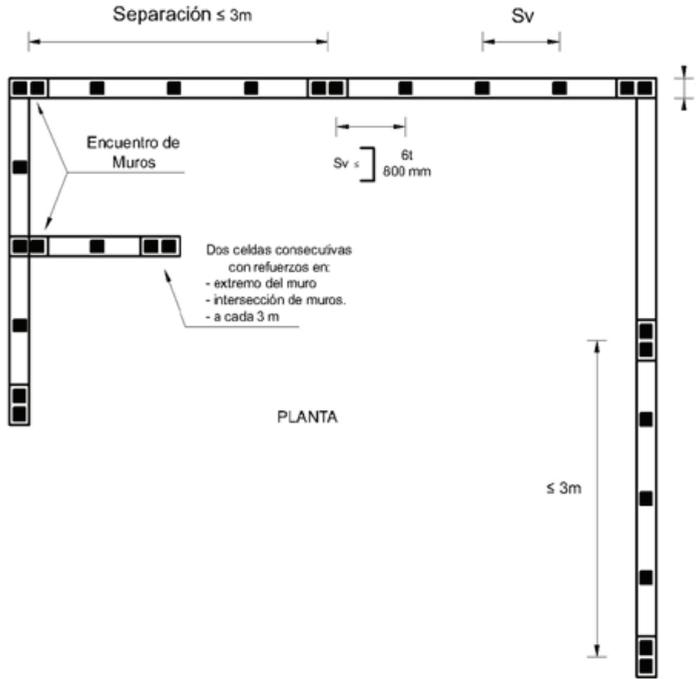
Planta típica de muros reforzados, ubicación del refuerzo vertical
